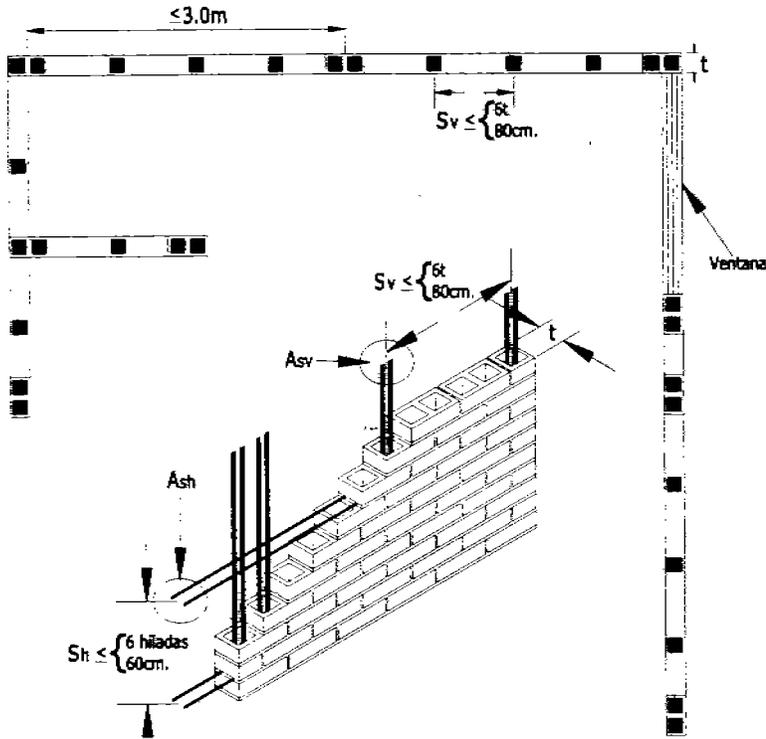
REQUISITOS PARA MAMPOSTERÍA CON REFUERZO INTERIOR
